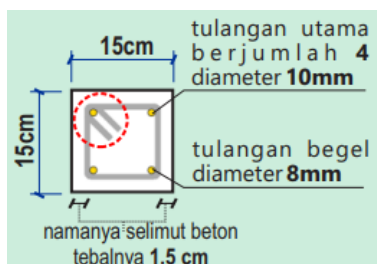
Kerusakan akibat Kesalahan Detailing Sloof
